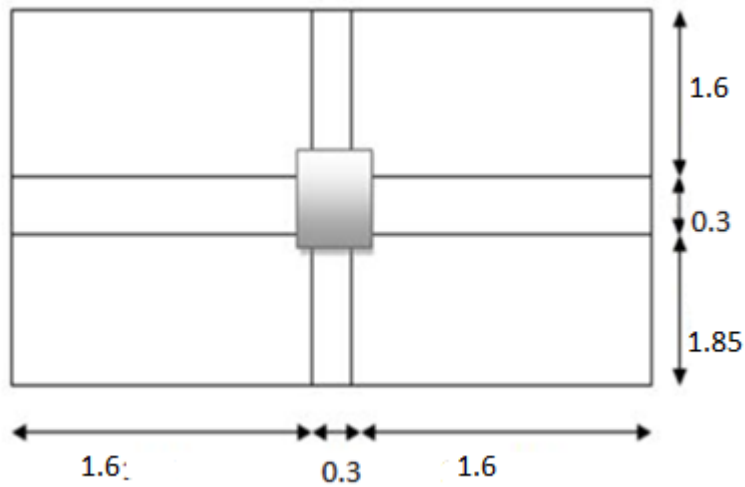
La surface afférente sur poteau intermédiaire(d3).
